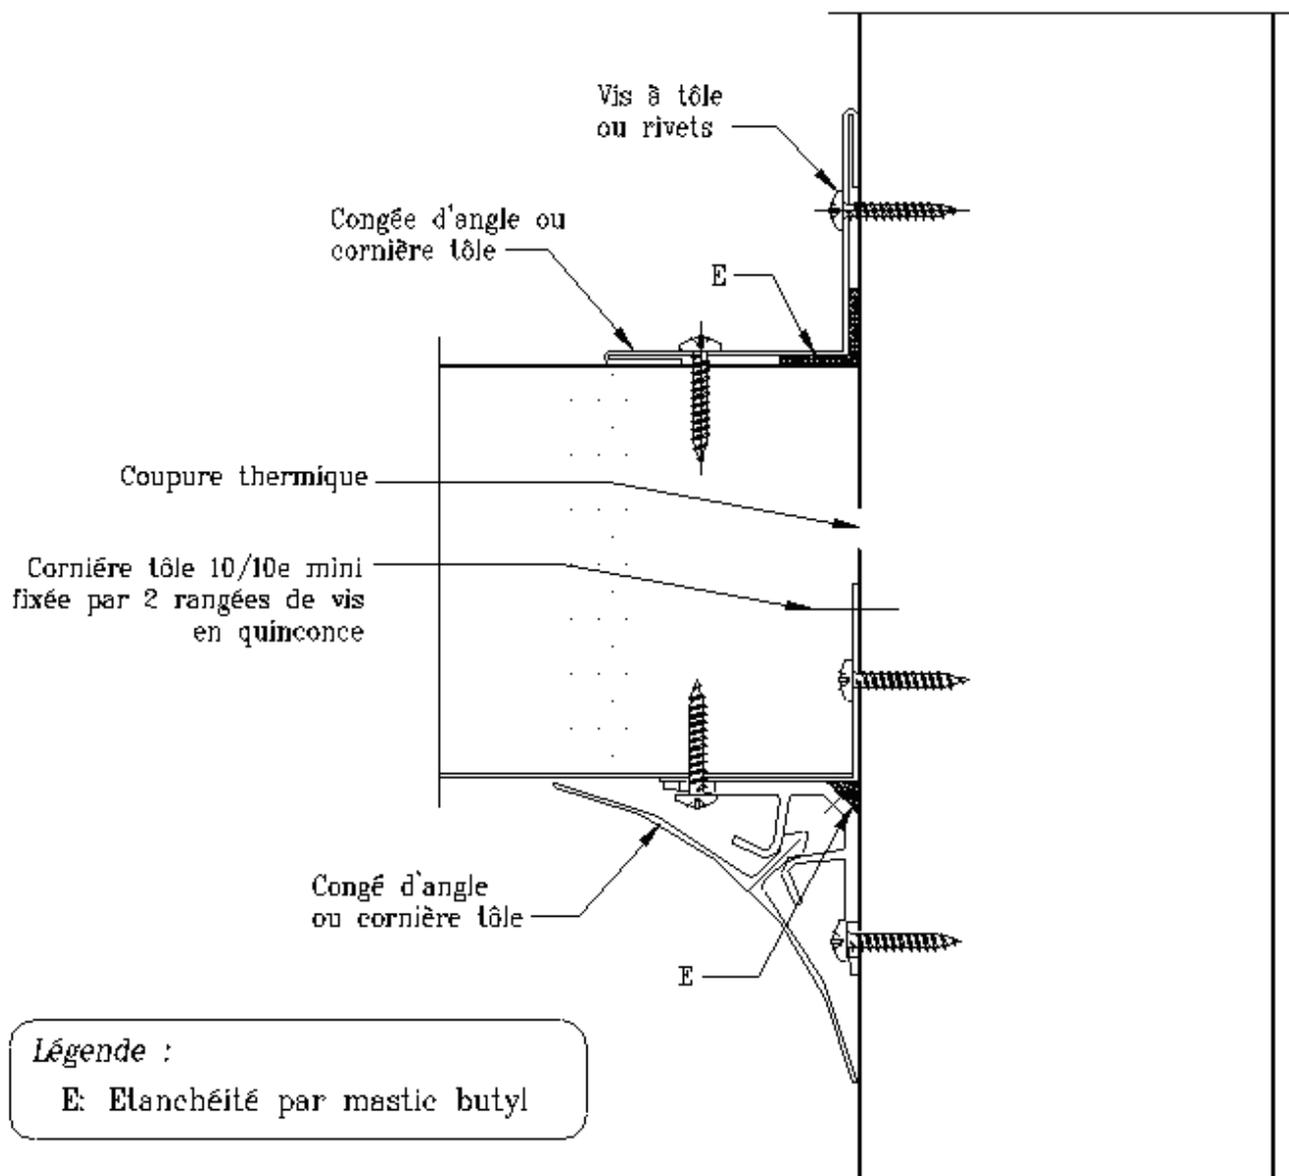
Raccordement paroi – paroi ou plafond - paroi
